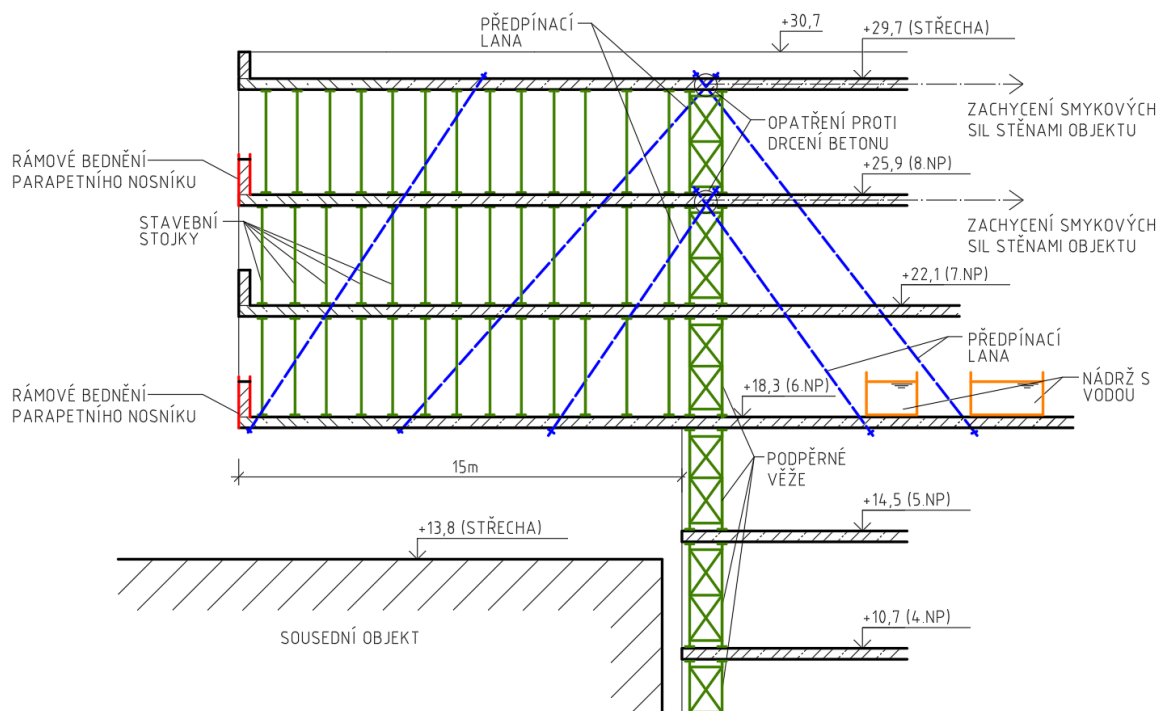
Schéma 8. záběru výstavby vyložené konstrukce
